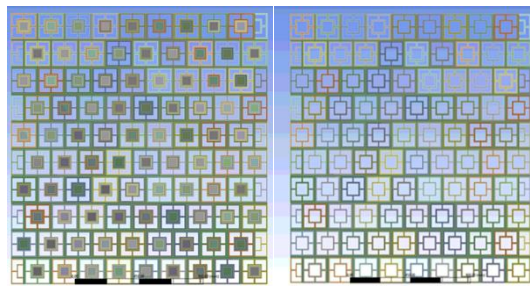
Muro configuración I núcleo de 6cm y primer muro de referencia.
